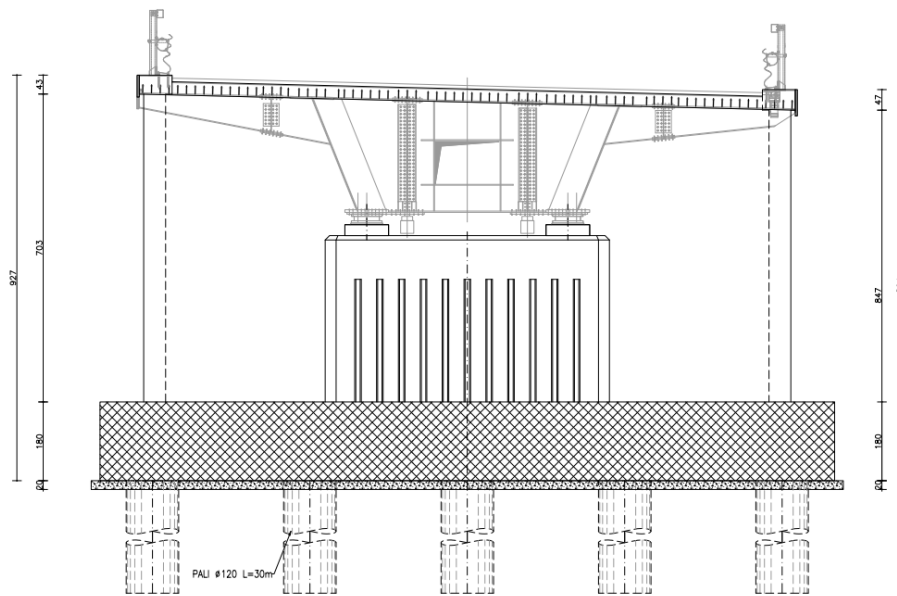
viste e sezioni principali – sezione trasversale in spalla
